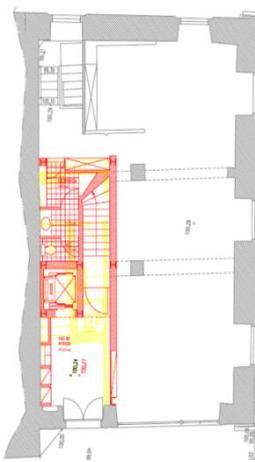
Planta do rés-do-chão (amarelo – demolições; vermelho – construção nova; cinzento – reabilitação)
